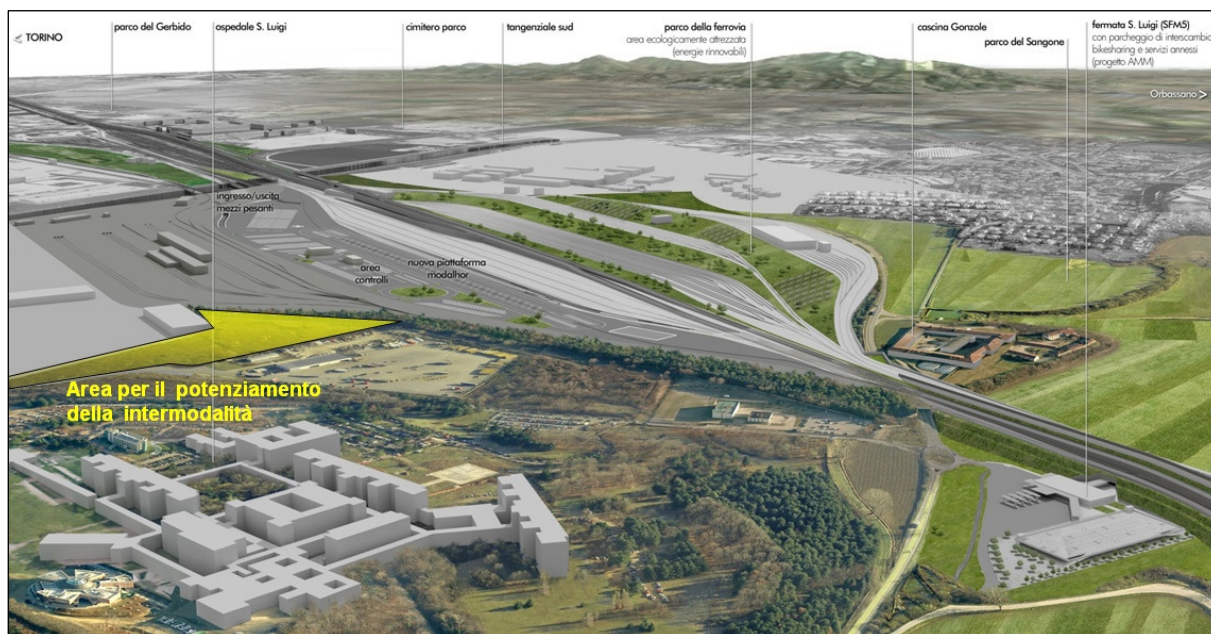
Lo scalo di Orbassano: ricostruzione prospettica con vista da nord-ovest
